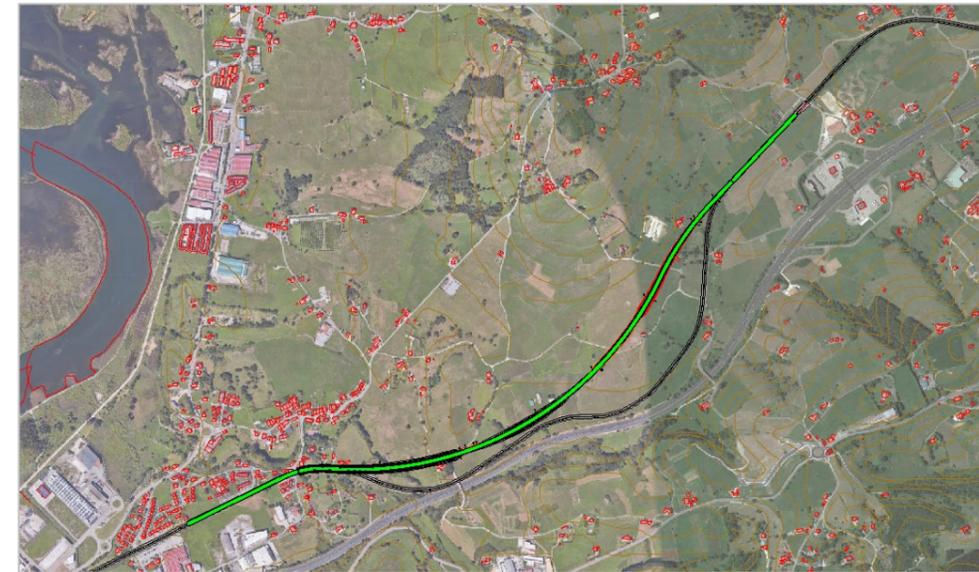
Trazado en planta entre Mar y Gornazo. Fuente: Autor
